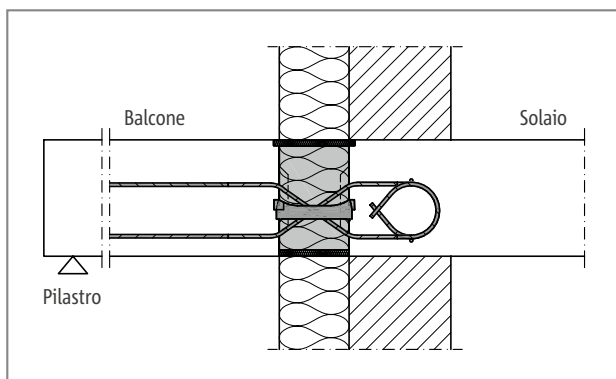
Schöck Isokorb® XT tipo QL-VV: raccordo con sistema di isolamento a cappotto
